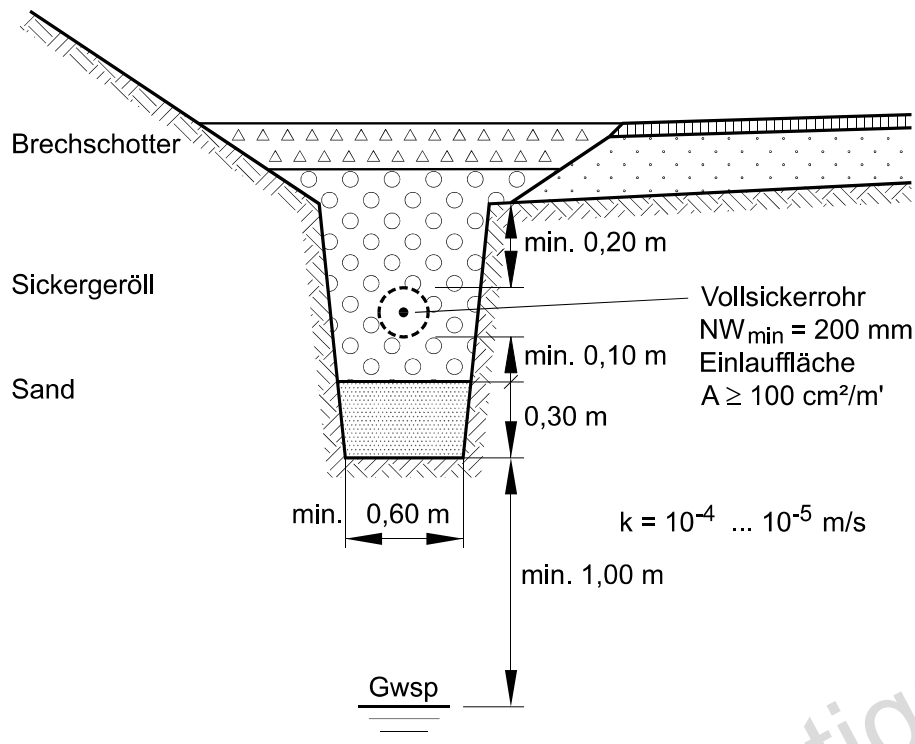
A88 : Drainage de type 3b, tranchée drainante avec tuyau d'infiltration plein (sable, galets d'infiltration).
